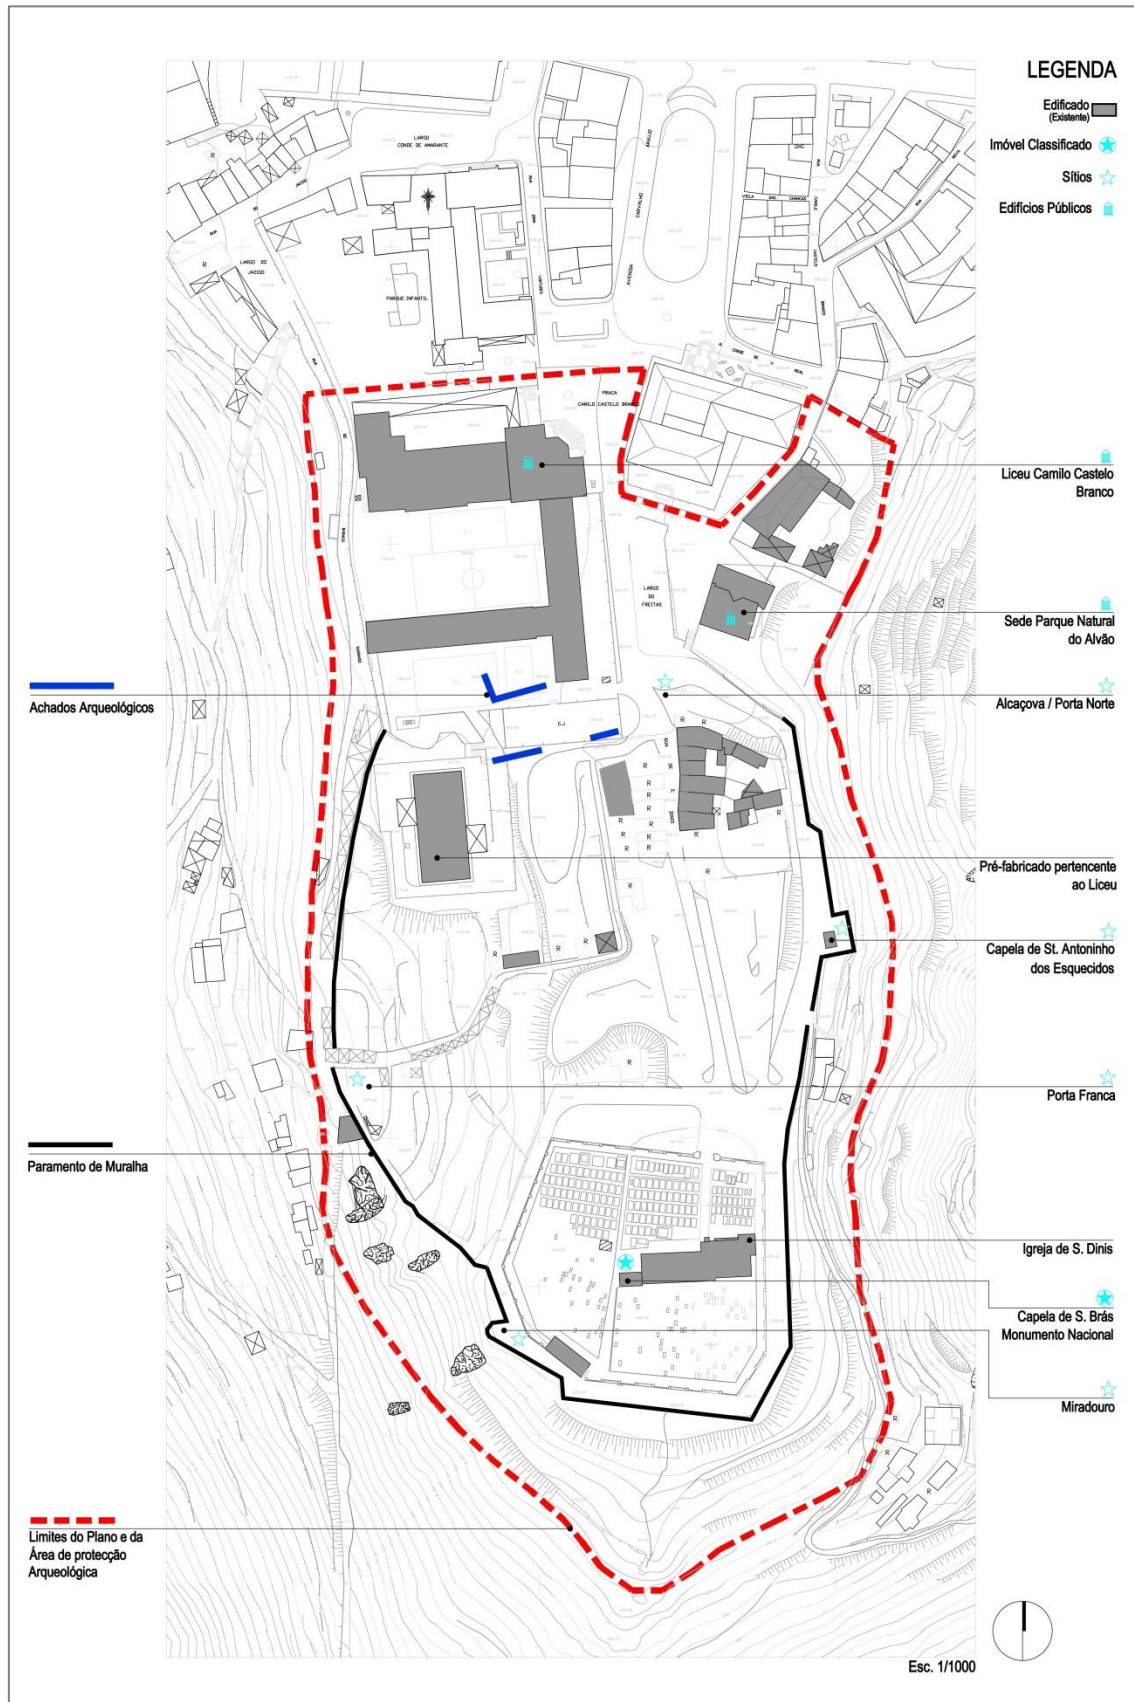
Extracto da Planta da Situação Existente do PPVV (2003)
